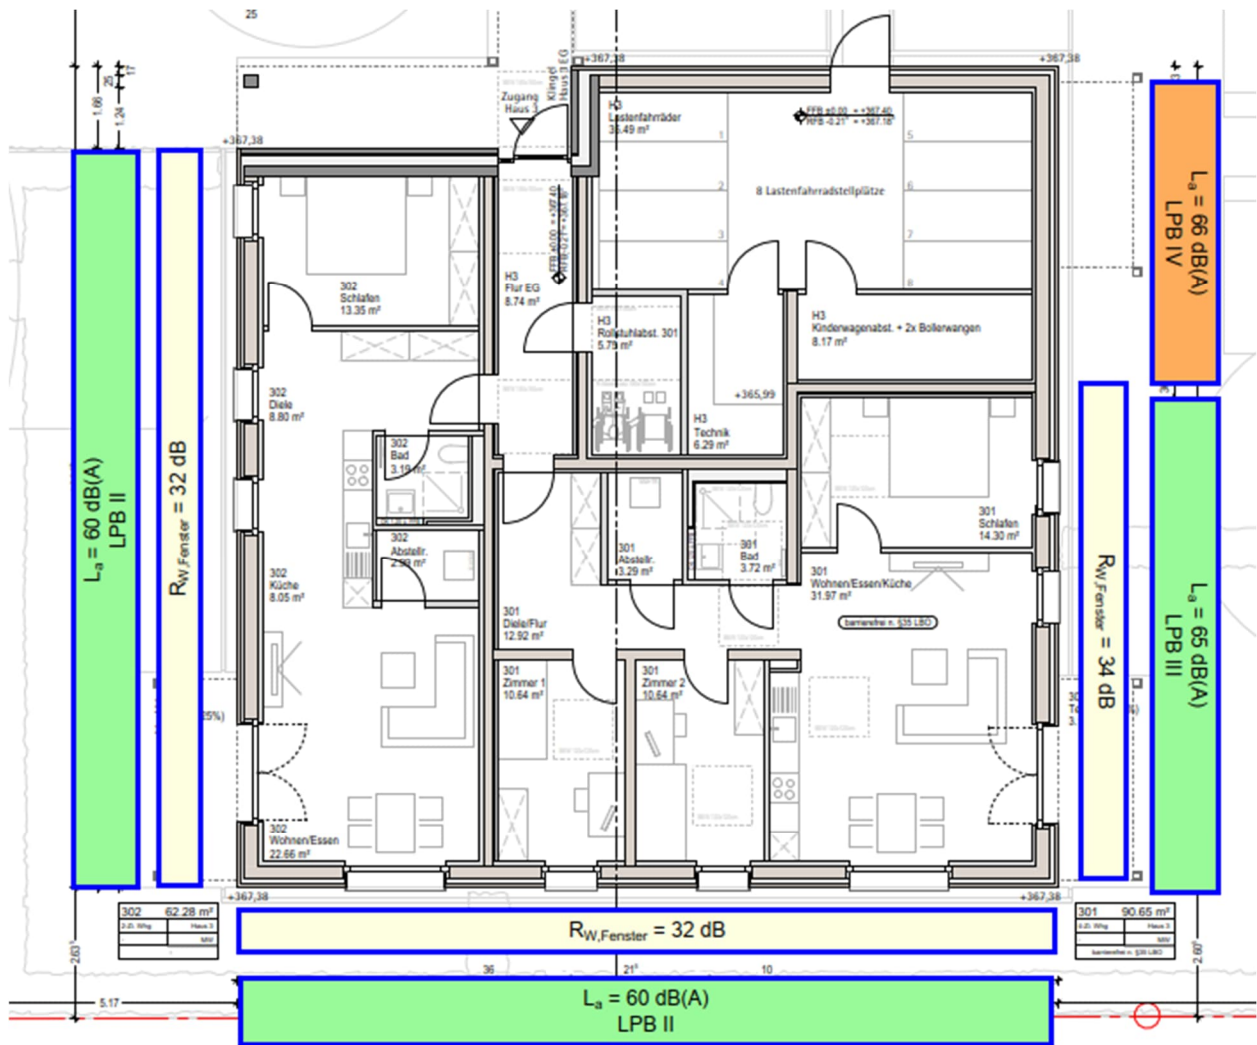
Außenlärm – Grundriss EG – Haus 3
